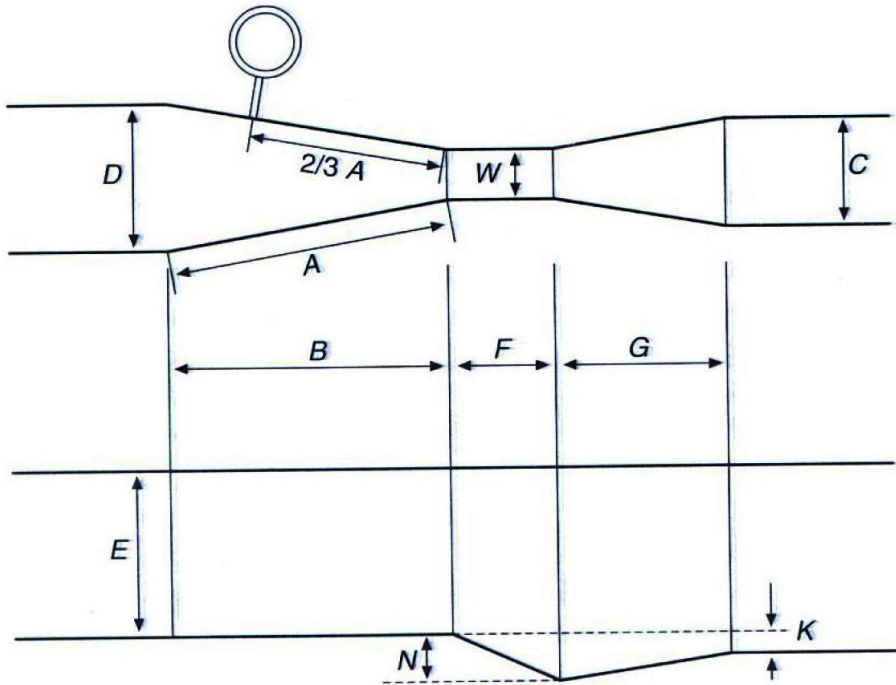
Planta e perfil de um medidor *Parshall
